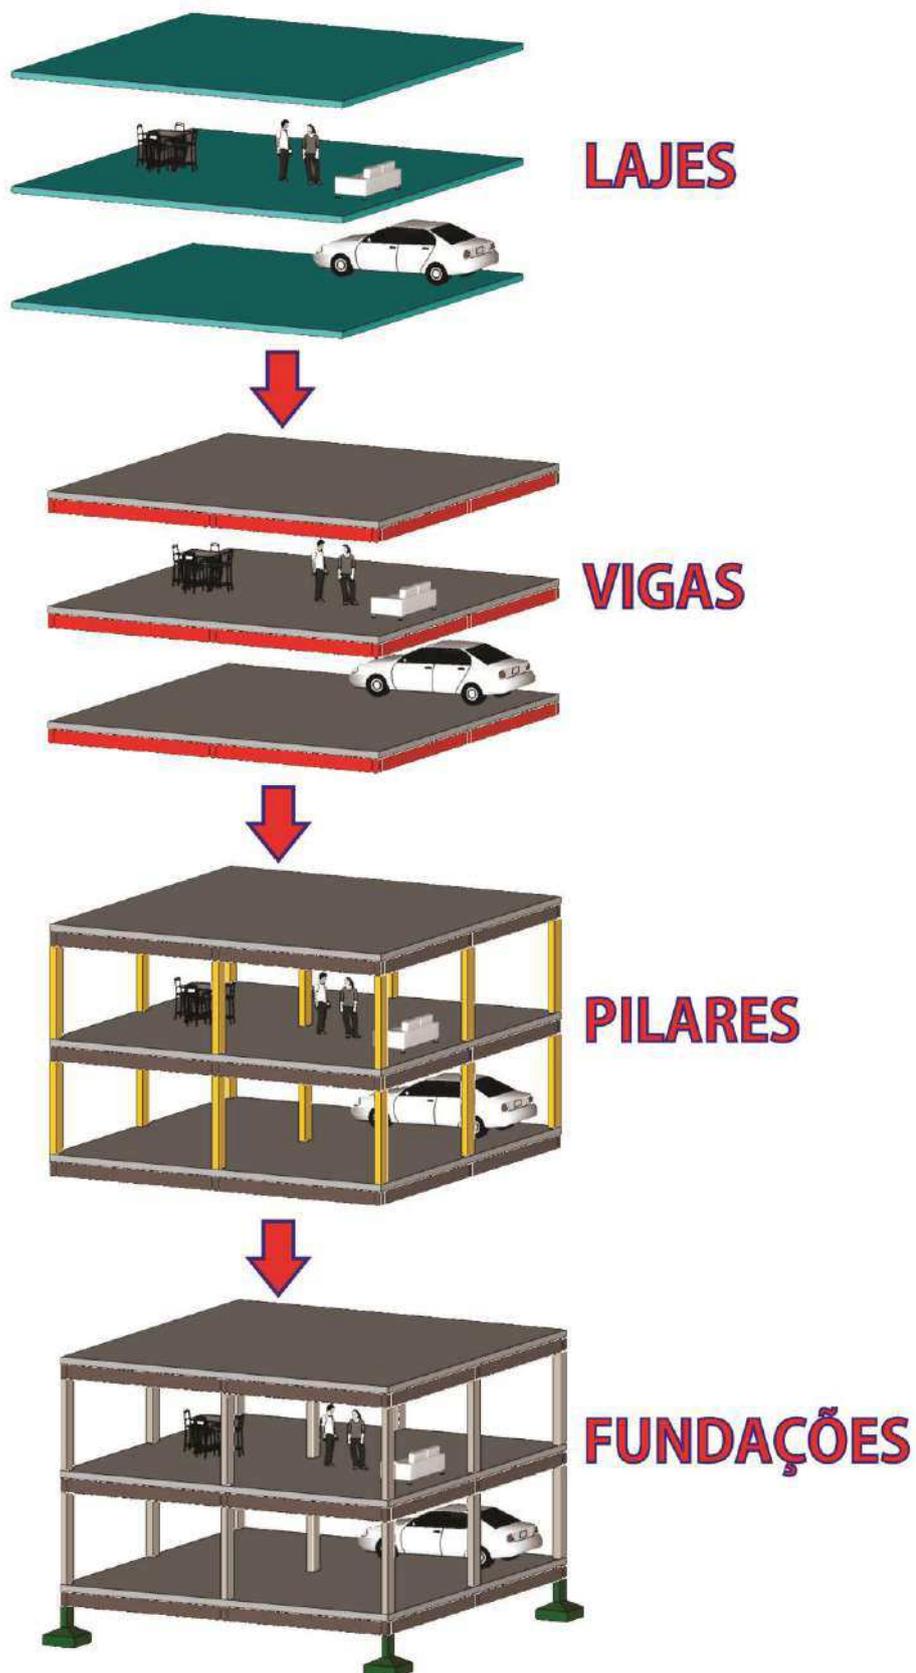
Elementos estruturais básicos – lajes/ vigas/ pilares/ fundações
